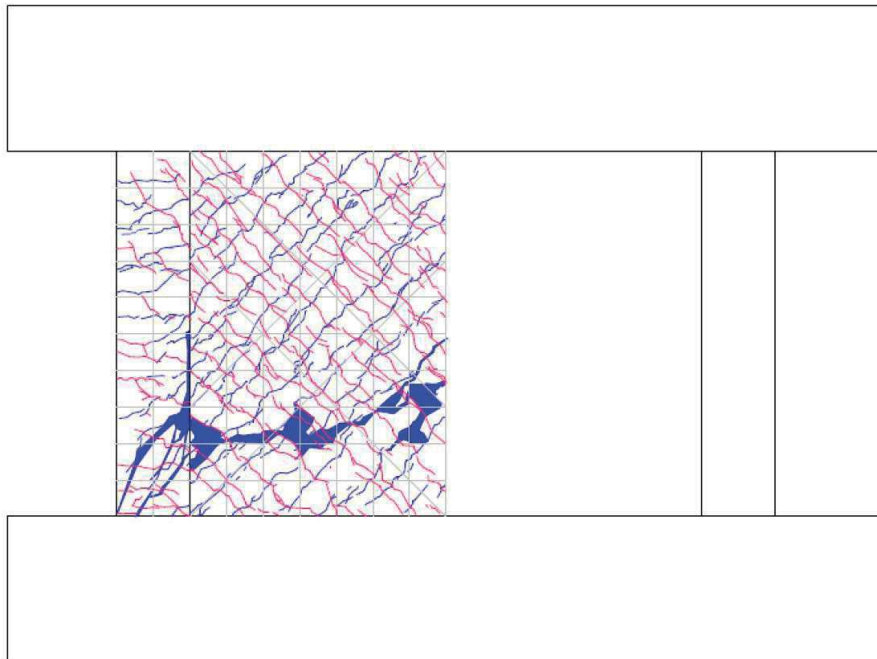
試験体 S-13-DIII 最終破壊時ひび割れ図
